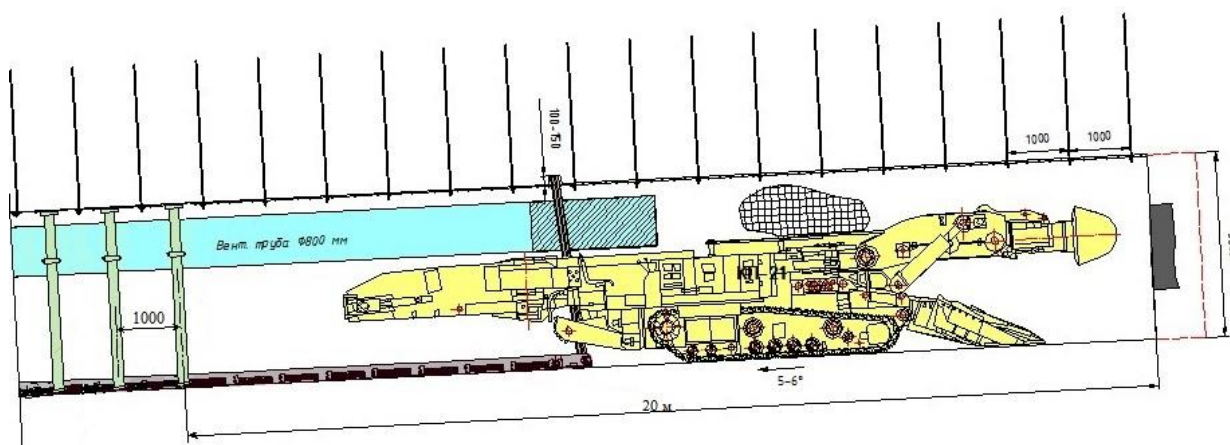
Продольный разрез вентиляционной сбойки № 1 с установкой комбинированной стоечно-анкерной крепи
